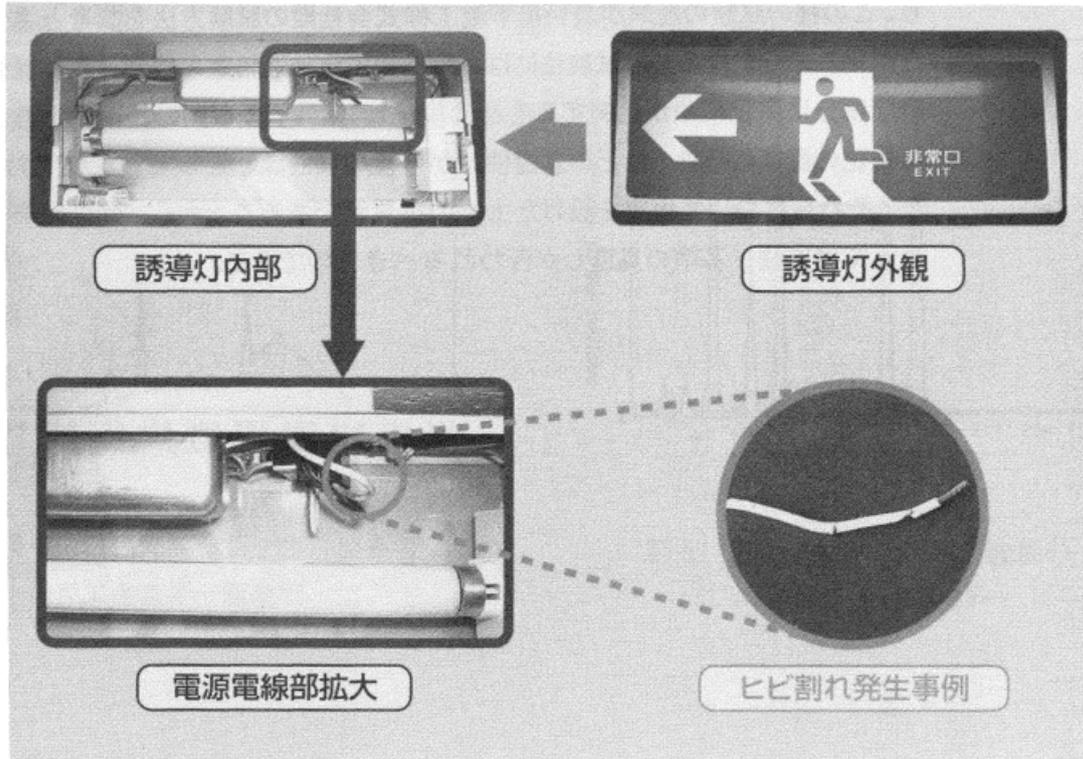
ーポリエチレン絶縁体のひび割れ事例①
